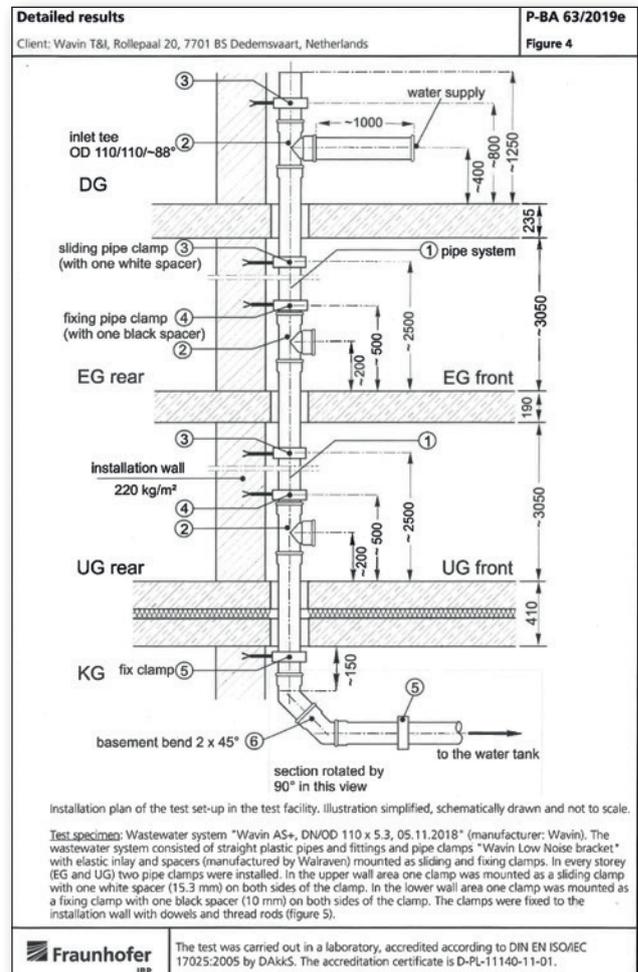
Installation de test FRAUNHOFER en laboratoire pour déterminer le niveau de bruit de l'installation.
